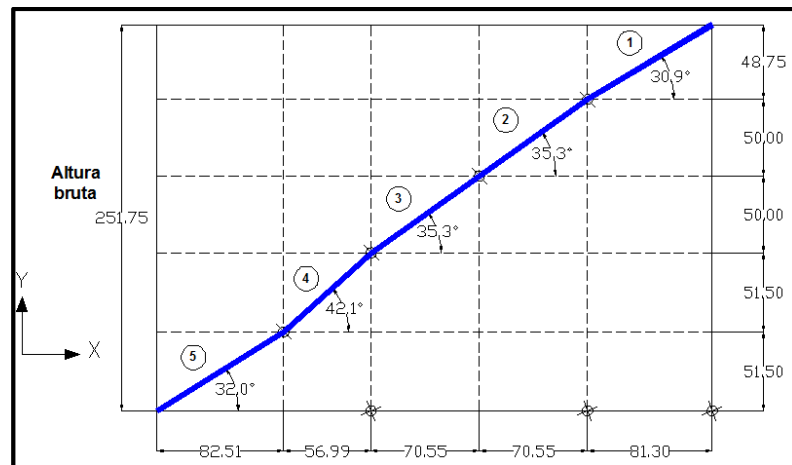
Perfil de terreno para montaje de tubería forzada.
